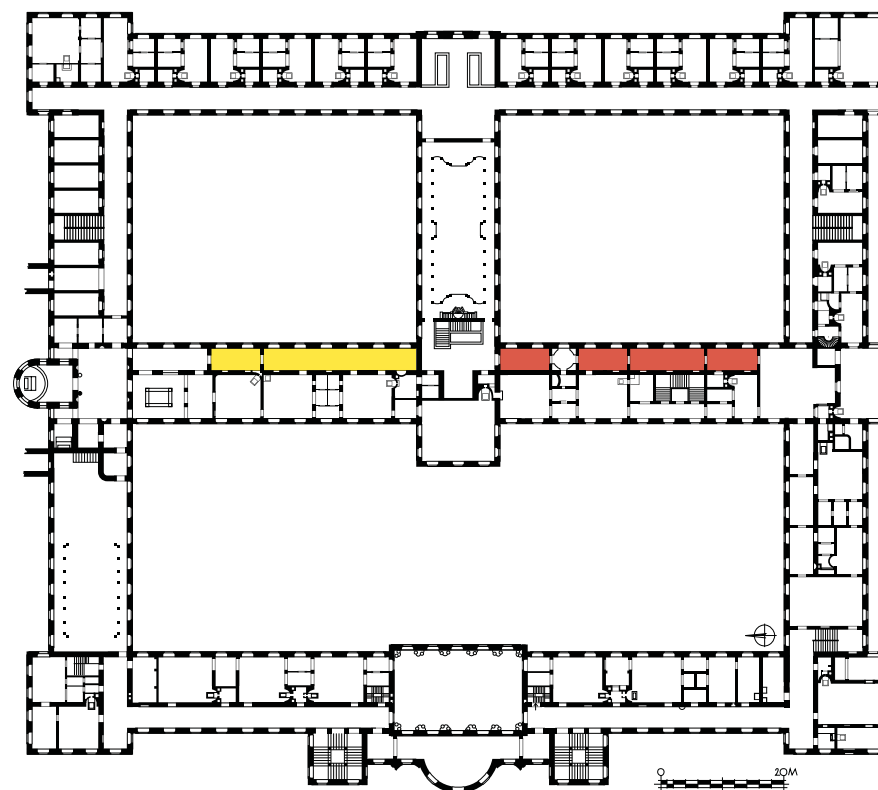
Benediktinerabtei Ottobeuren, Klostergebäude, 2. Obergeschoss: Grundriss mit Markierung der von Abt Rupert Ness angelegten Galeriezimmer
